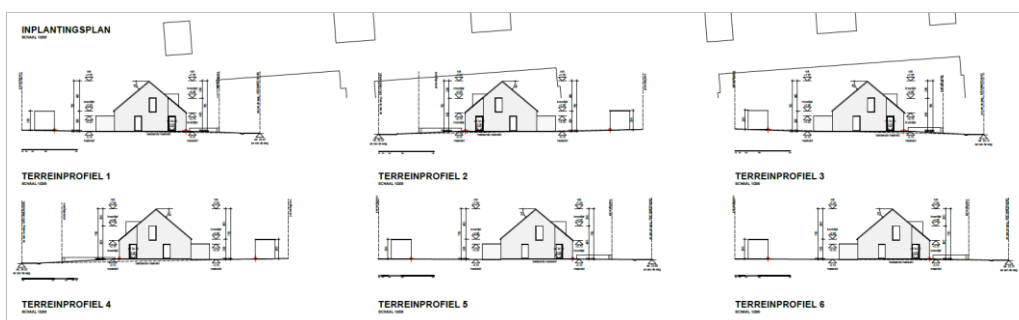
Plan van de geplande werken (Vooruitzien cvba, 2019)
